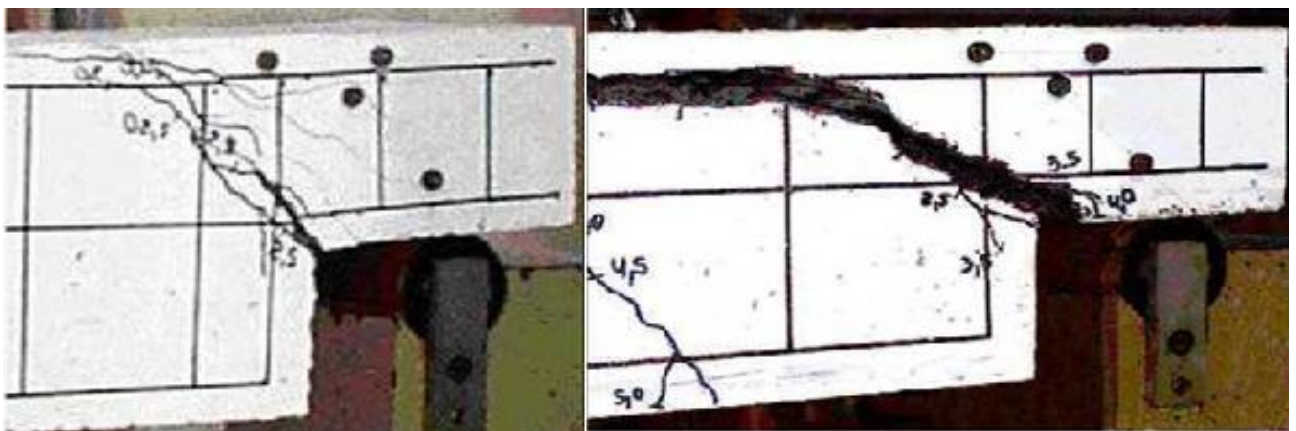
Fissuras na face do canto reentrante de dentes Gerber devido a escoamento ou ruptura armadura que atravessam as fissuras
